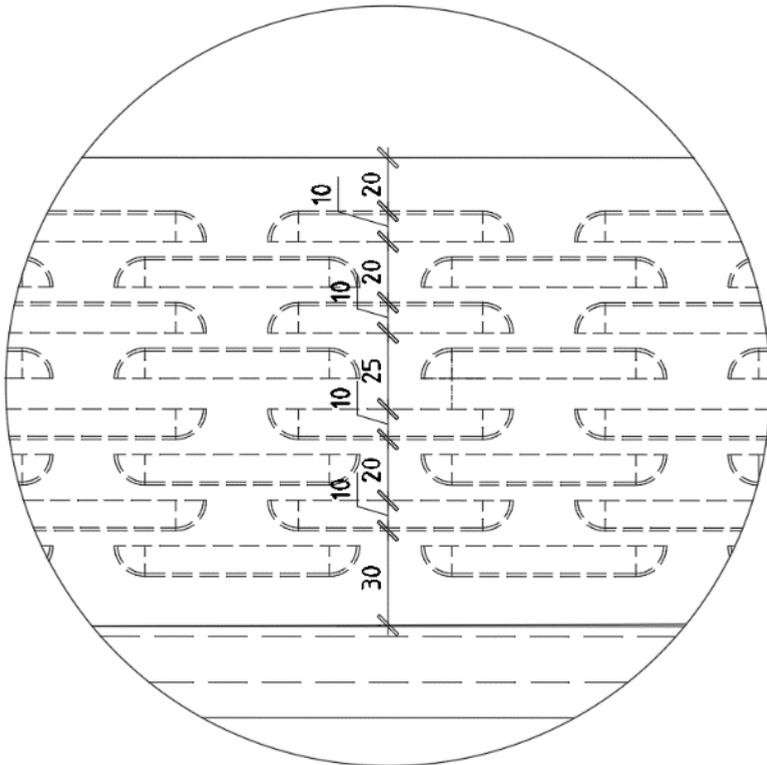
Vista de termoperfil con sus ranuras unilaterales rellenas con aislamiento térmico. Fuente: Elaboración propia.
